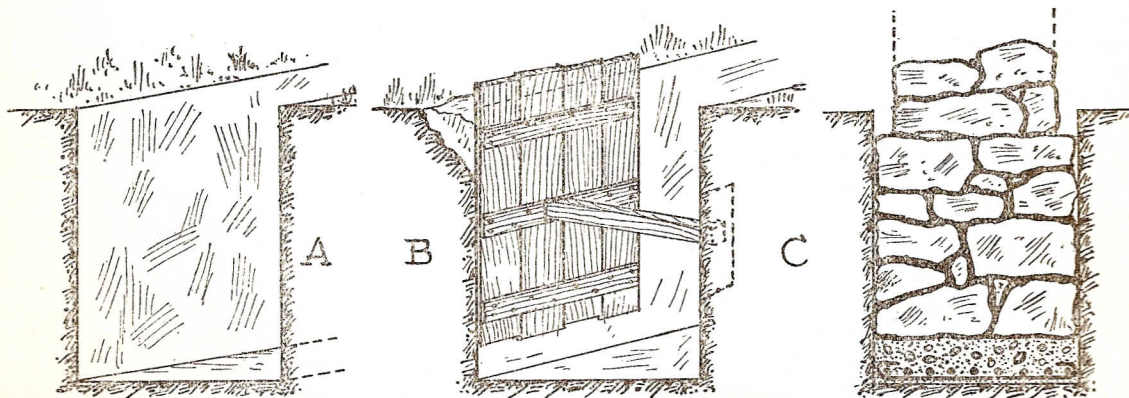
DIVERSAS FUNDAÇÕES: A) FUNDAÇÃO ABERTA NORMALMENTE; B) FUNDAÇÃO ABERTA EM TERRENO MOVEDIÇO; C) FUNDAÇÃO CHEIA DE ALVENARIA SOBRE SAPATA DE BETAO ARMADO
